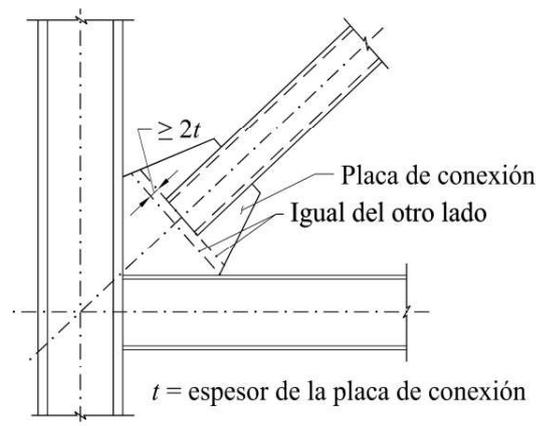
Geometría requerida de la placa de conexión (NTC-Acero, 2023)
